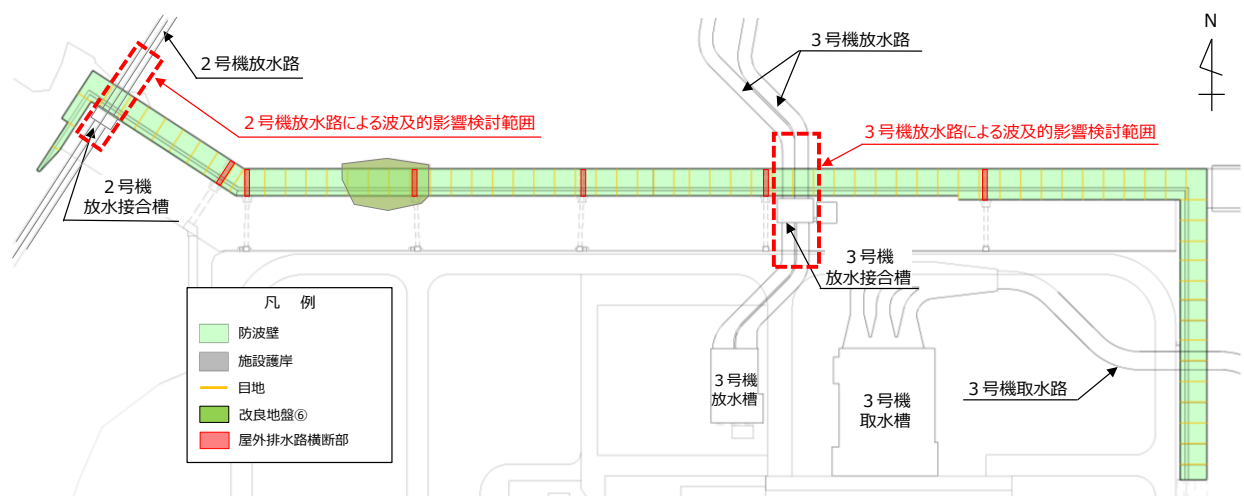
2号機放水路及び3号機放水路の平面図
